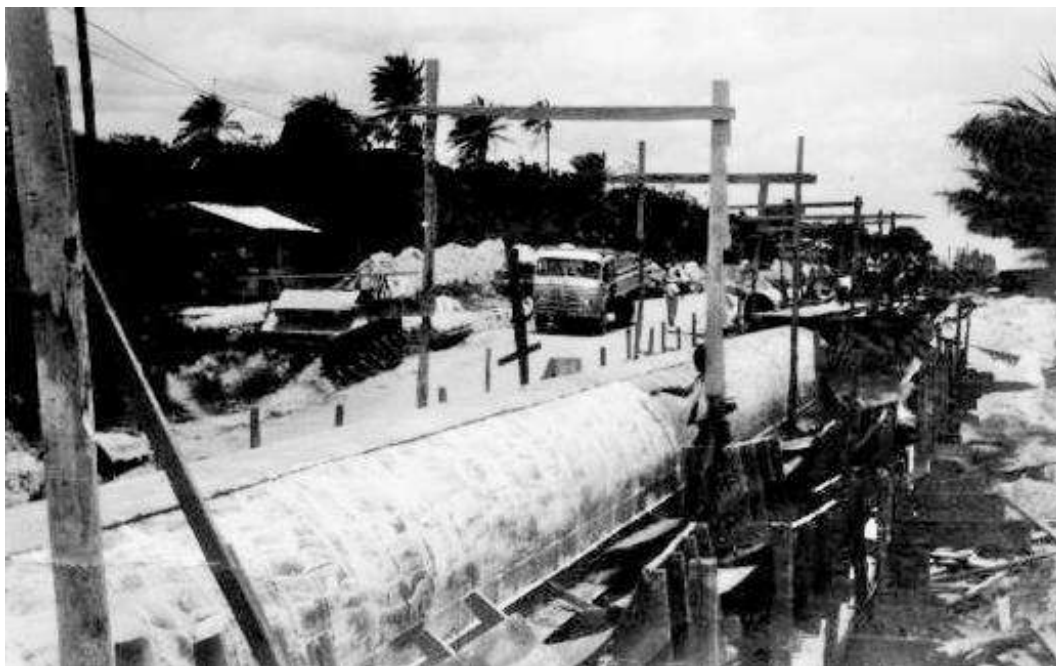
Vista parcial de um dos tubos, após removidas as formas da segunda fase, e durante a aplicação do agente de cura ANTISOL da SIKA. O tubo já está fissurado.
